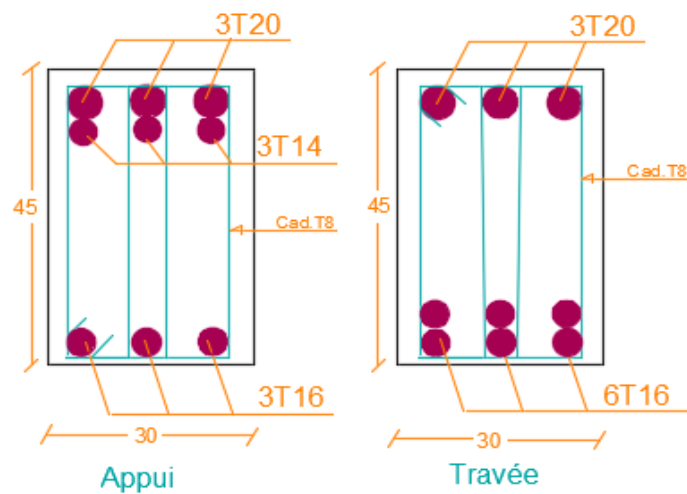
Ferrailage Des Poutres Non Porteuses Des étages courants.
